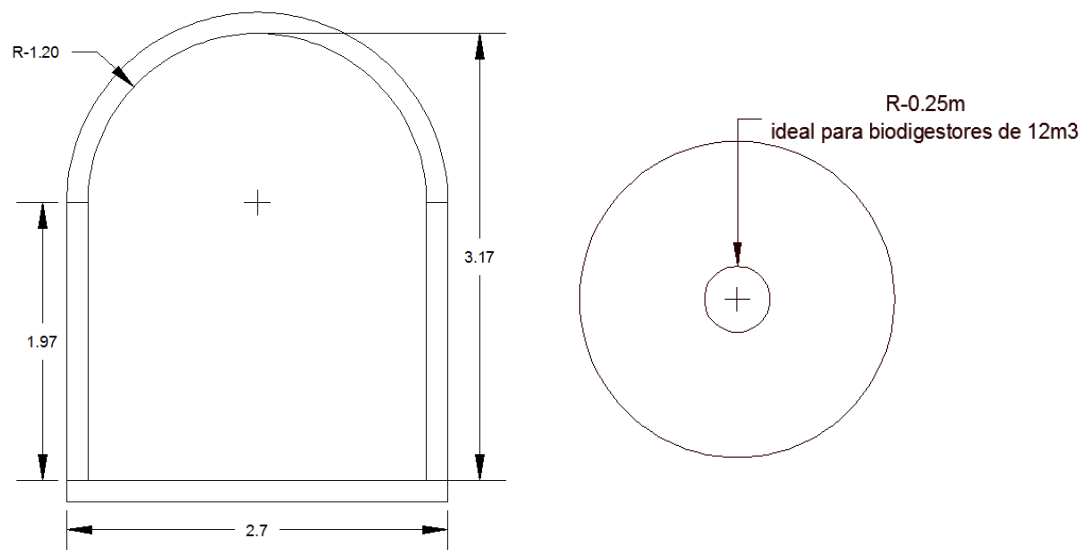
Dimensiones del biodigestor corte longitudinal (Izquierda) y planta (Derecha)
